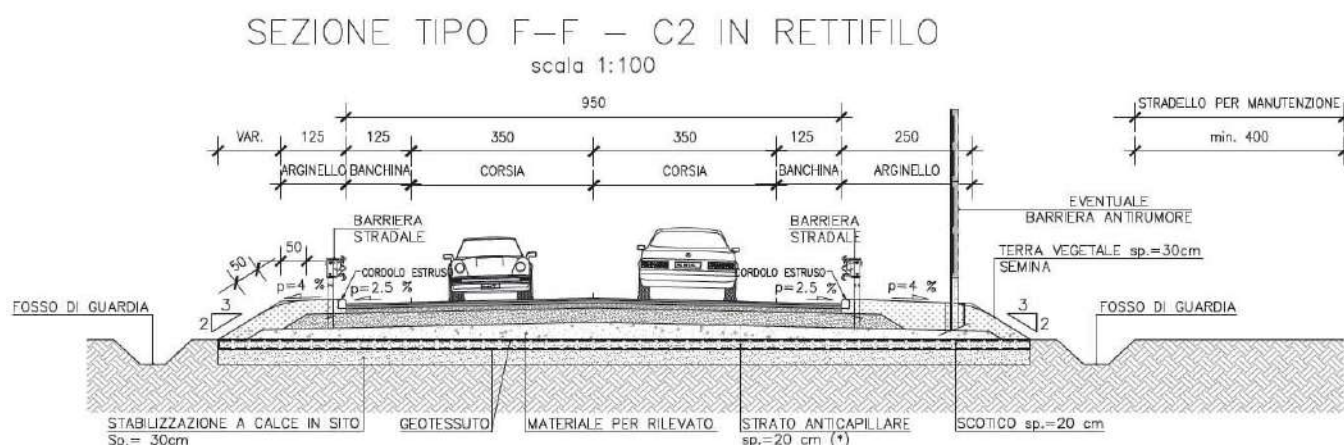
Sezione tipo piattaforma C2 in rettilo
